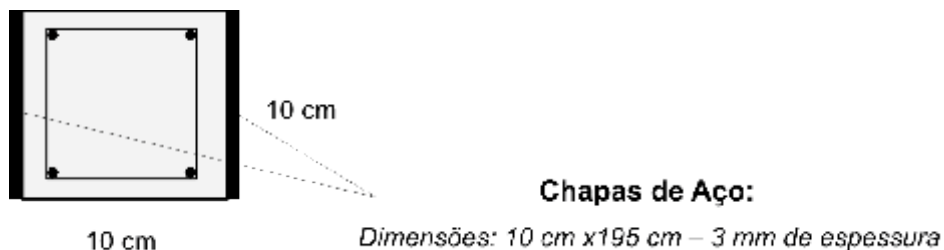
Seção transversal do pilar reforçado com chapas de aço.
